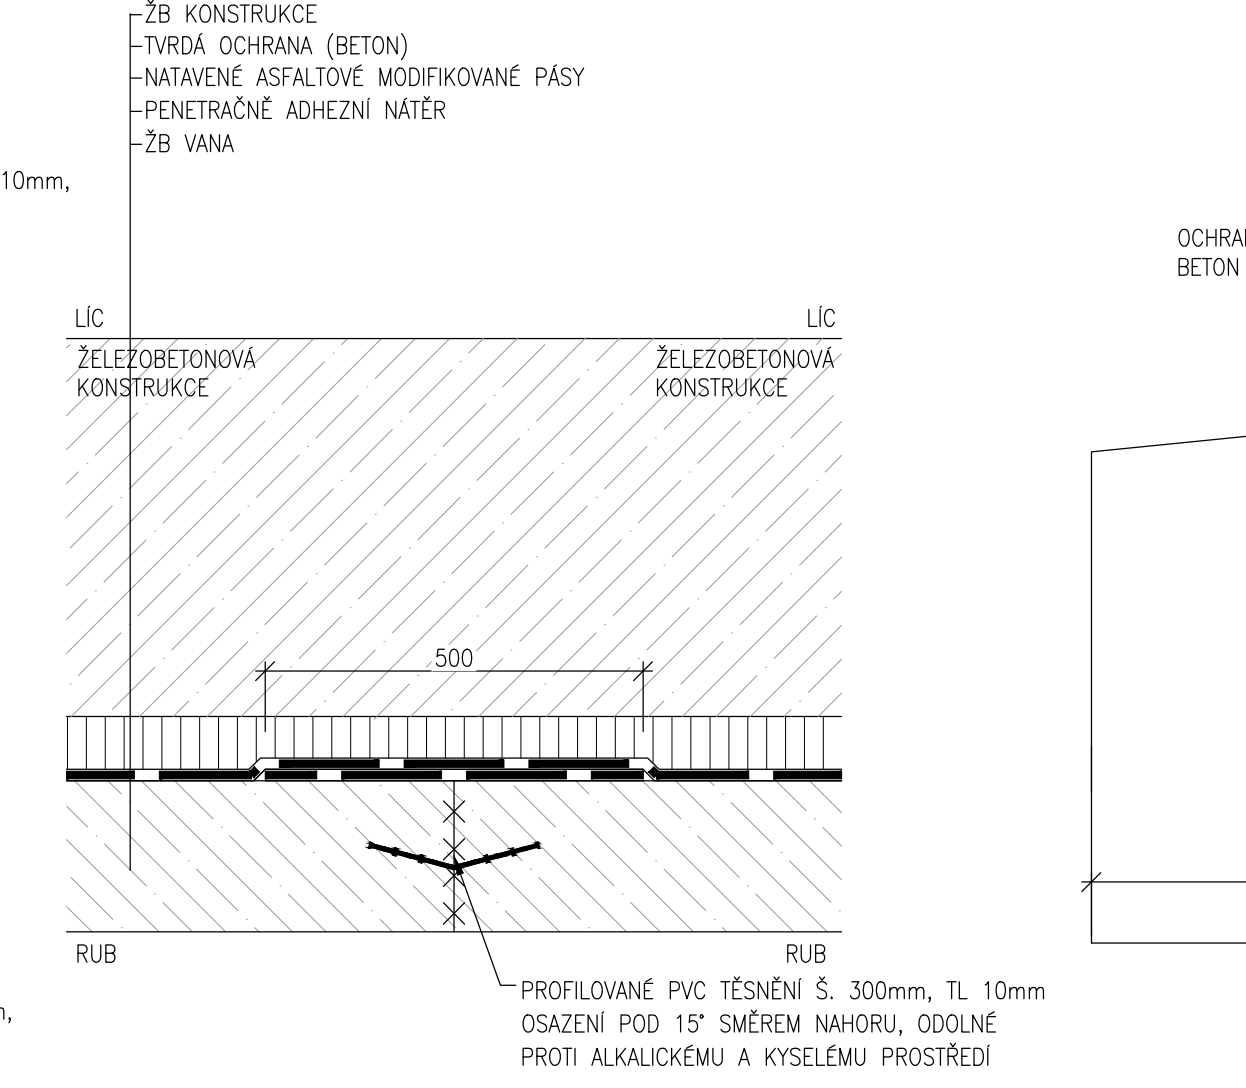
DETAIL ÚPRAVY PRACOVNÍ SPÁRY VE STĚNĚ
